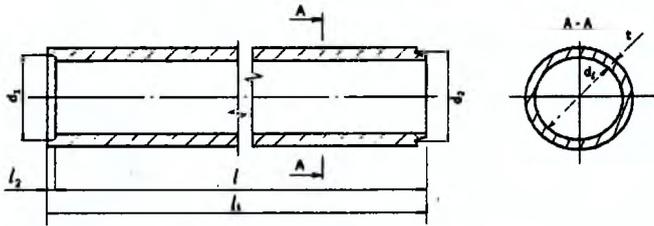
Общий вид труб типа ТФ (БТФ) – железобетонных (бетонных) цилиндрических фальцевых
